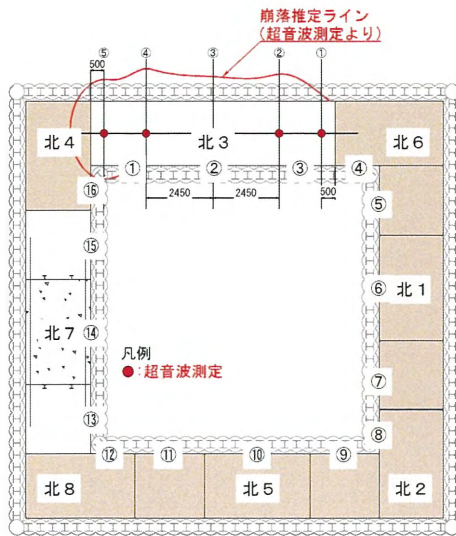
コンクリート未充填箇所断面図 (SMW直下 T.P. -13.0 m 付近)
